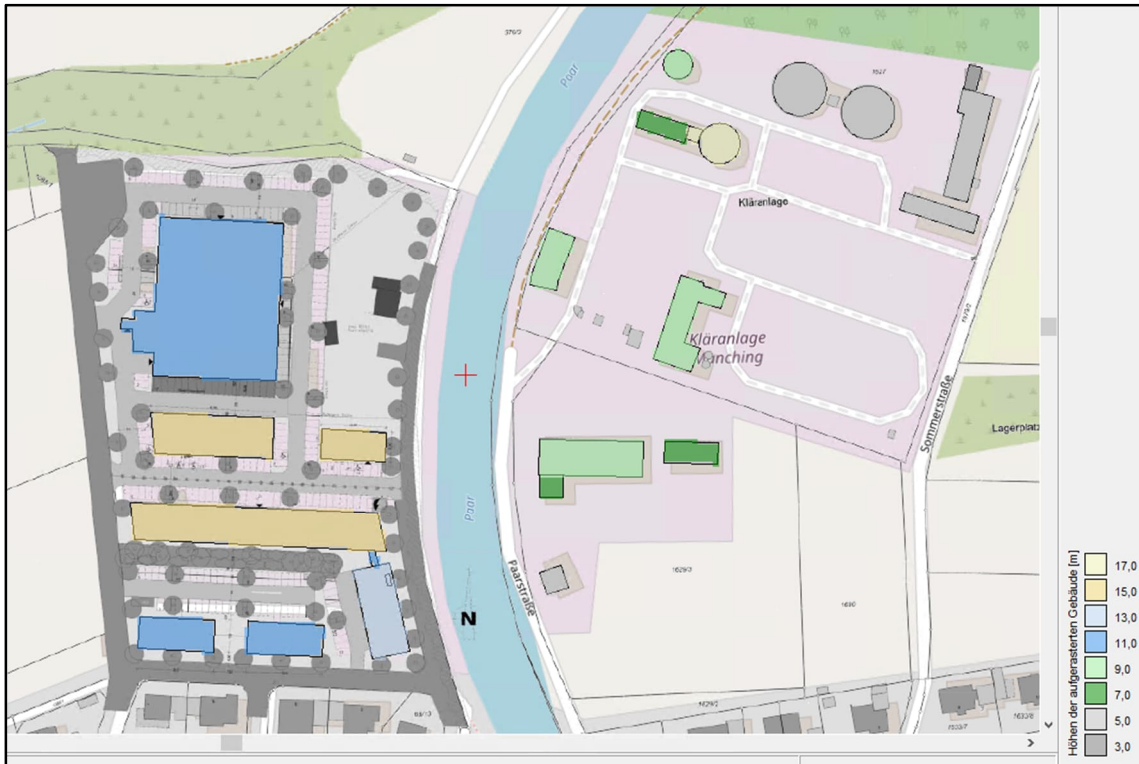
Lageplan mit Darstellung der gerasterten Gebäude
